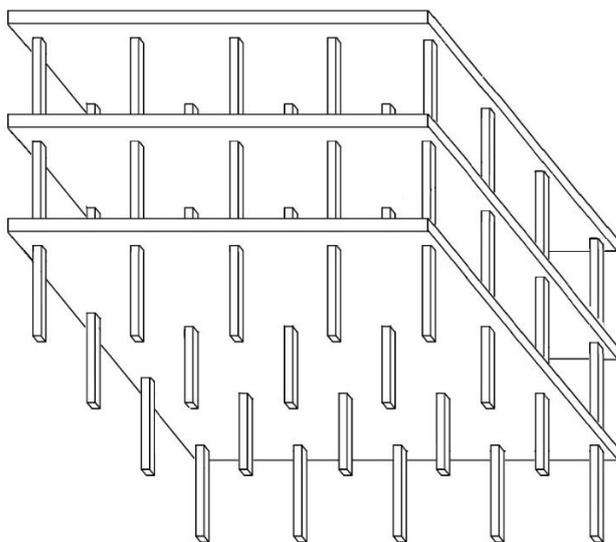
Конструкція залізобетонного каркасу з безкапітельно-безбалковим перекриттям
